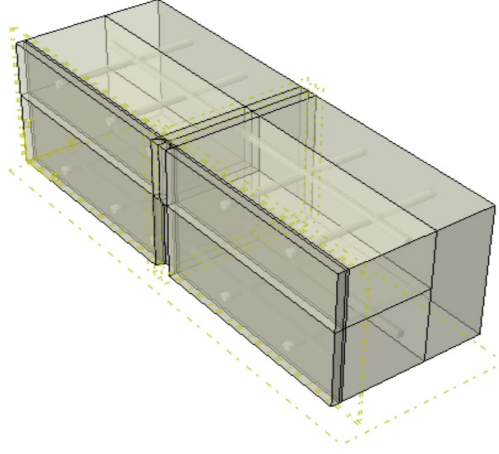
Çelik profil başlığına merge edilmiş stud çivisi.
